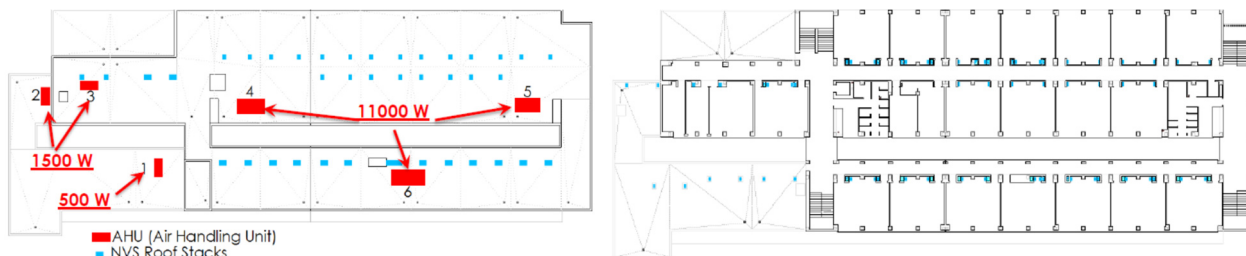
Edificio test. a) izda: cubierta; b) dcha: planta primera.
